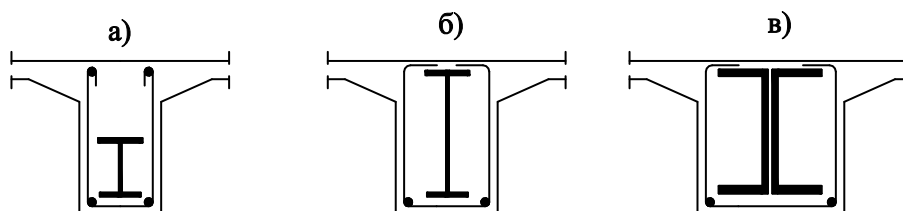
Полное обетонирование двутавров (а,б) и швеллеров (в), используемых в качестве жесткой арматуры ребристых сталежелезобетонных перекрытий [1,2]
